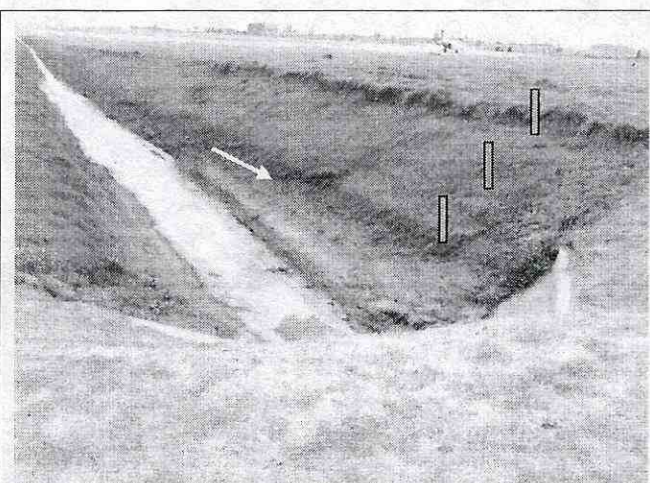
Detalle del encole de la estructura de entrega al río Bogotá. Se muestra la ubicación propuesta para los tramos de mira de monitoreo del canal.
